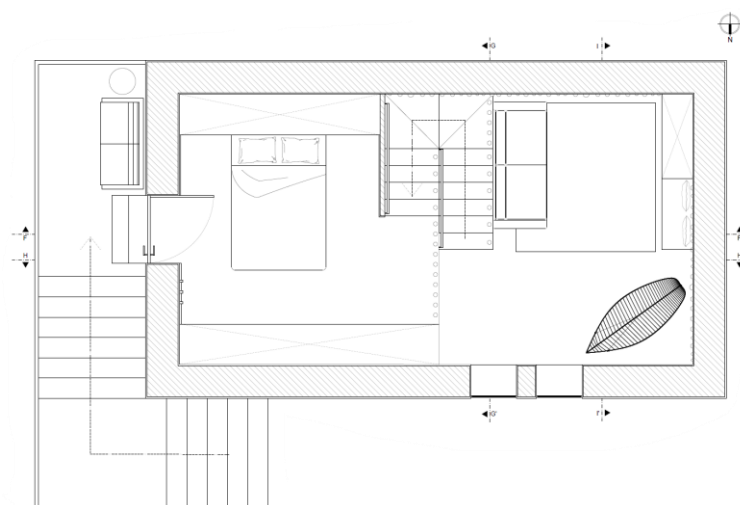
Pormenorização, Alojamento Til, Mezzanine.
